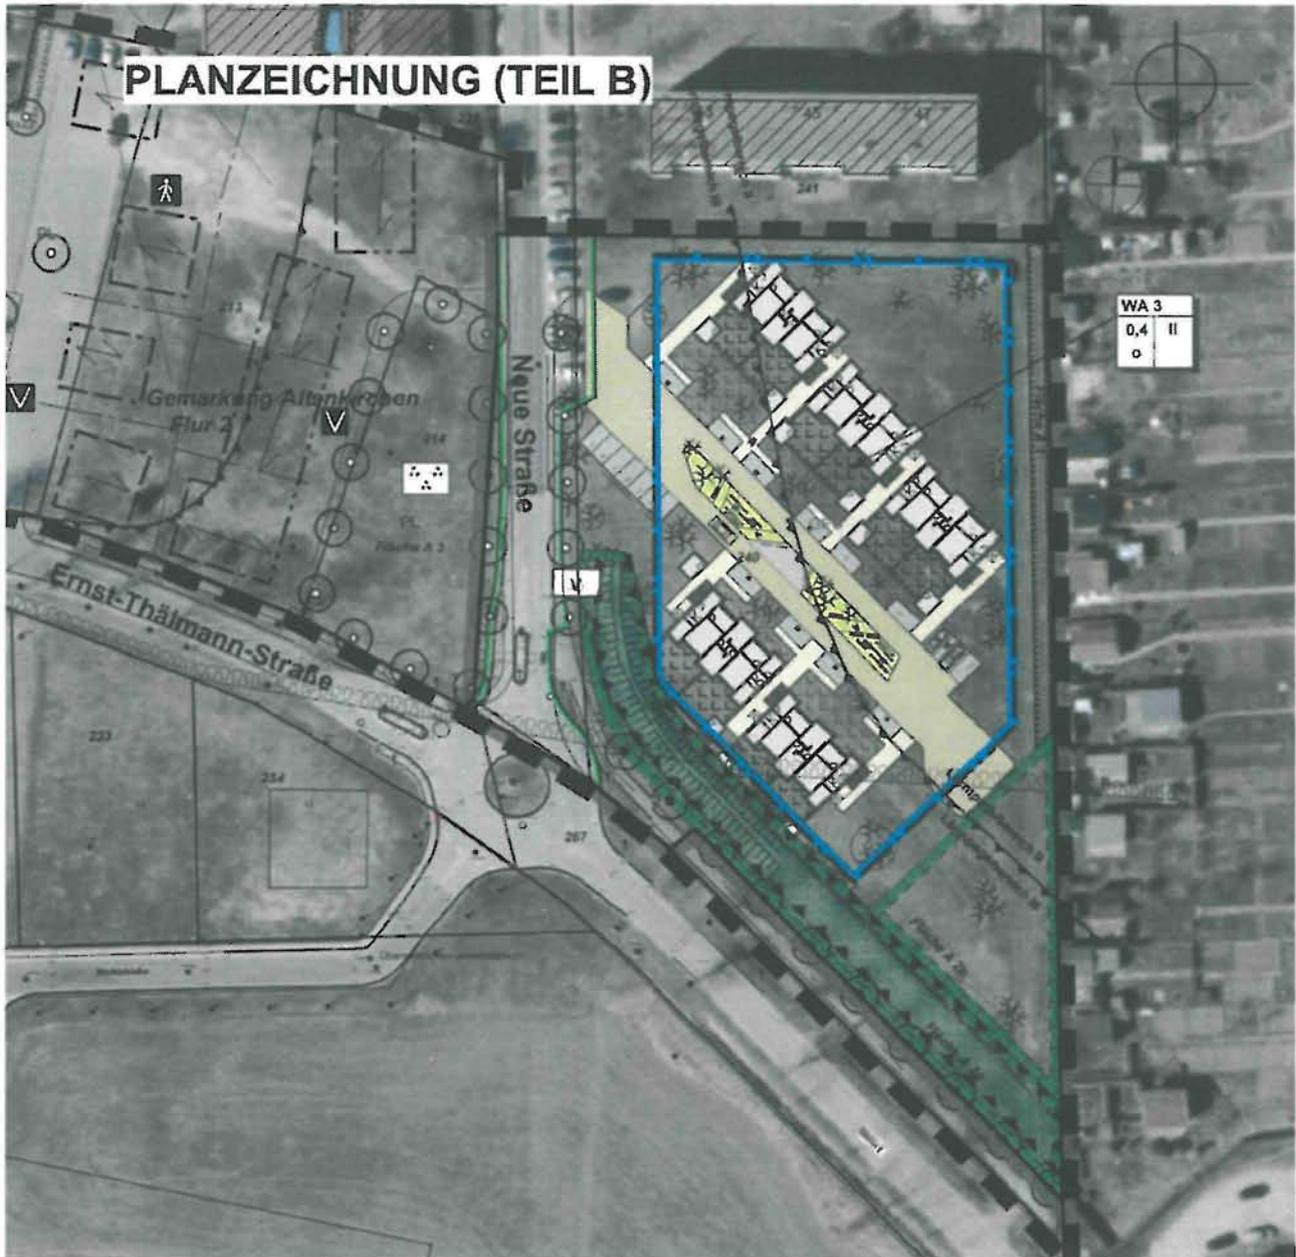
planungsrechtliche Festlegungen mit geplanten Gebäuden
